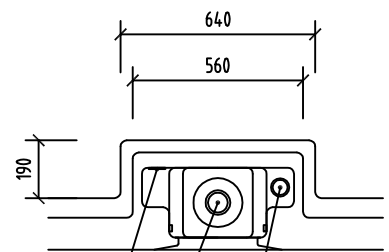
DETAIL ÚPRAVY INTEGROVANÝ SKIMMER M 1:25
